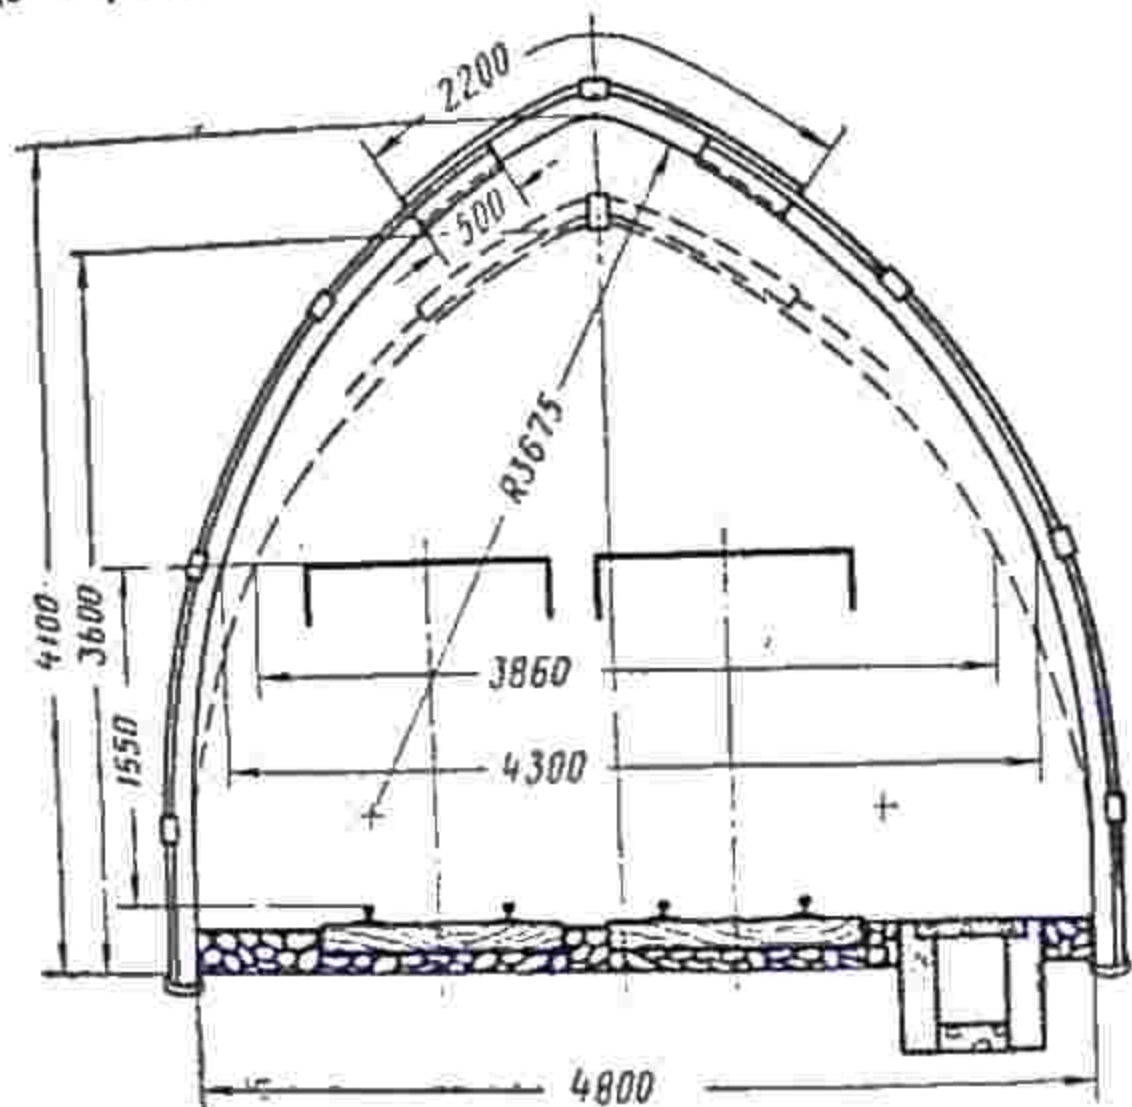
Трехарочная арочная податливая крепь стрельчатой формы
